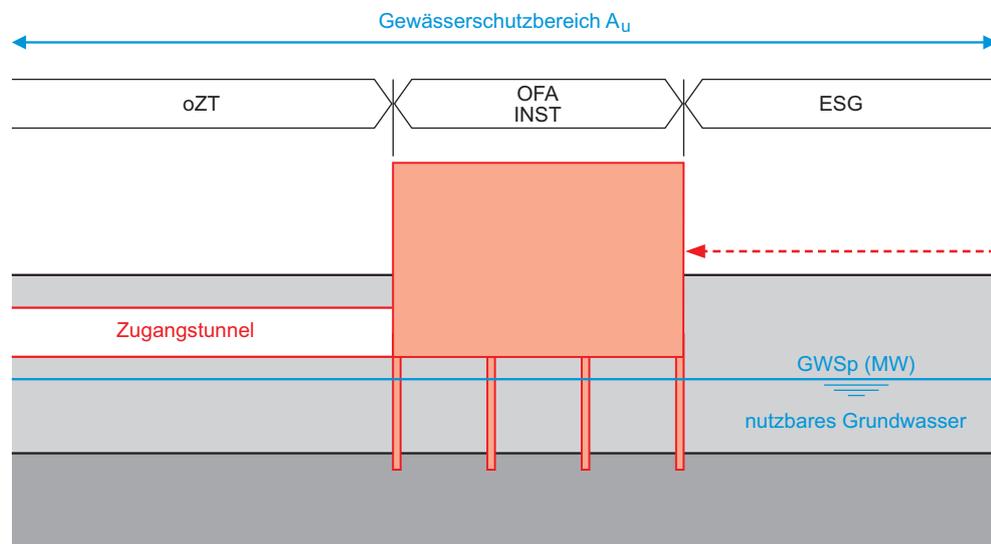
Grundwassersituation Typ D – Bauwerk im Gewässerschutzbereich A_u über dem nutzbaren Grundwasser mit einem Baugrund mit schlechter Tragfähigkeit.
